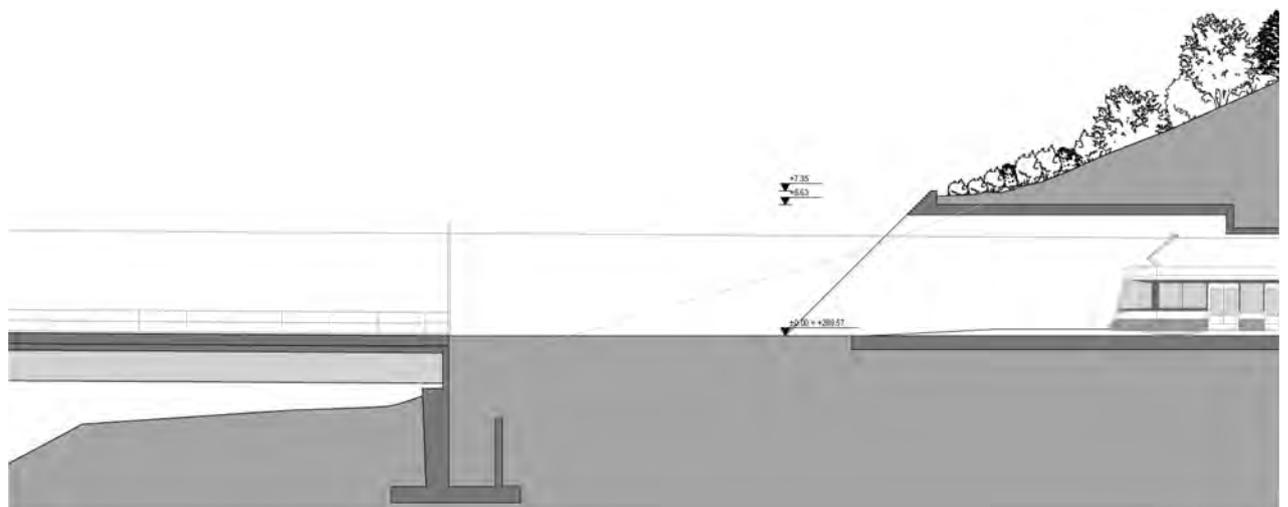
Sezione longitudinale nella zona del portale ovest e della spalla del viadotto.
